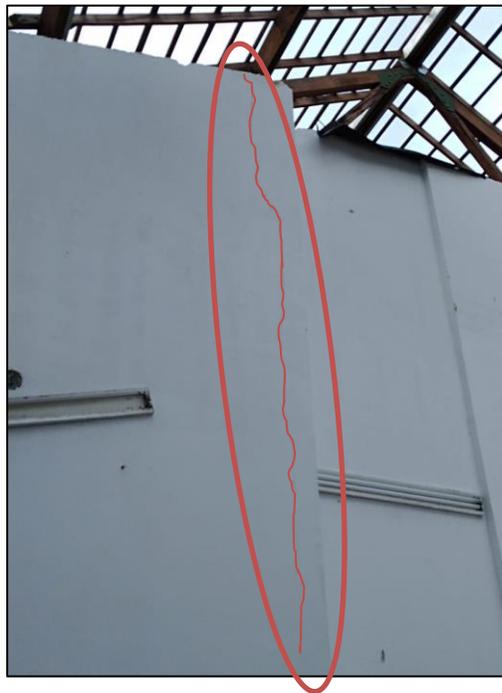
Muros fisurados del bloque B5 – Galería
